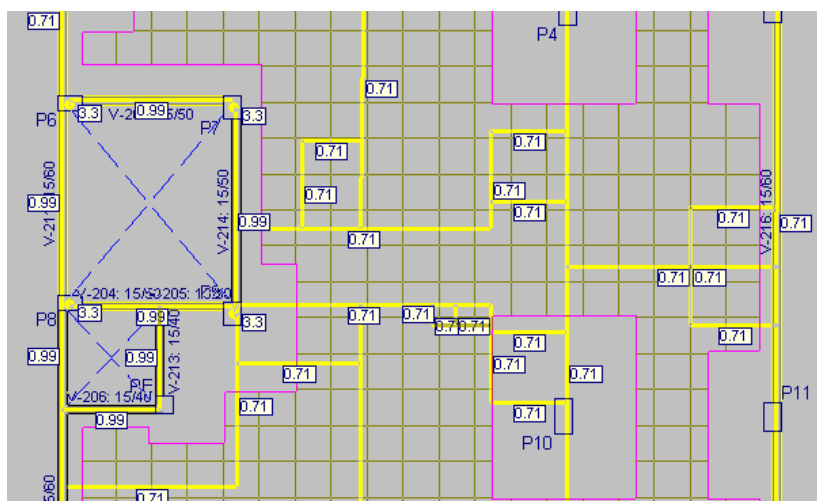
Trecho de laje com cargas de alvenaria e cargas pontuais sobre pilares.
